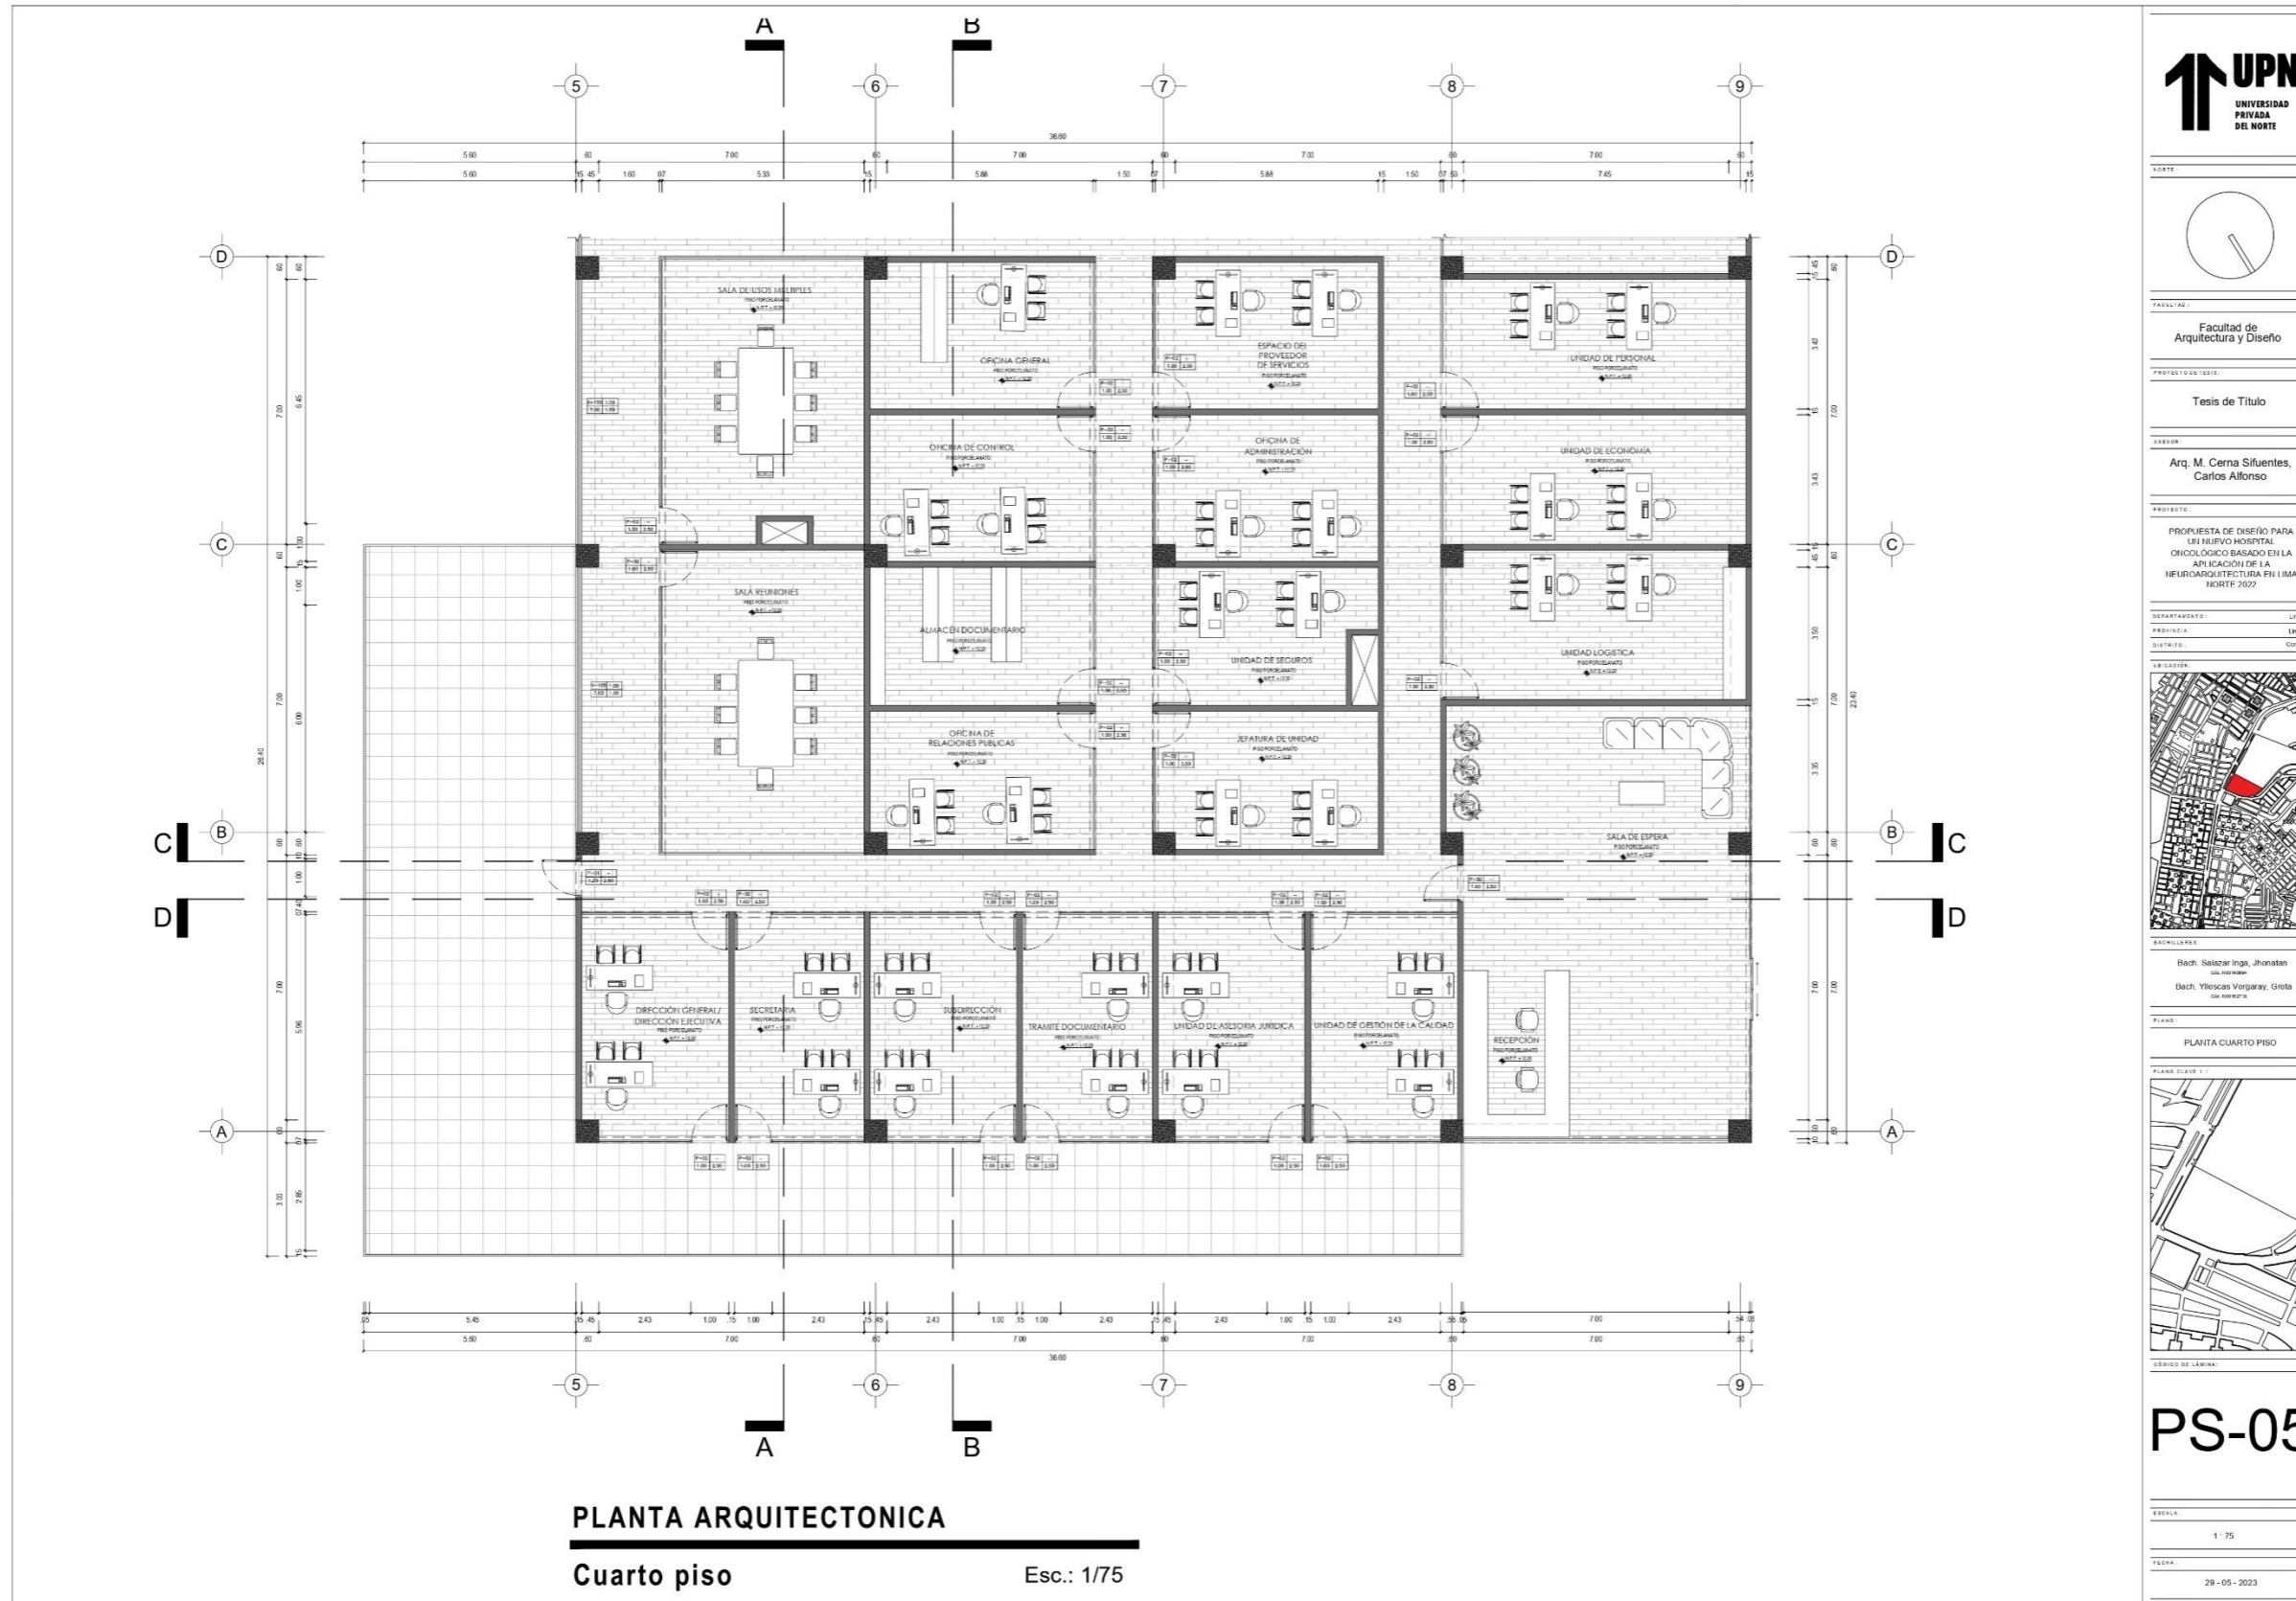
Arquitectura – Planta nivel N°4 del sector cuadrante Esc: 1/75 (Fuente: Elaboración propia de los coautores)
